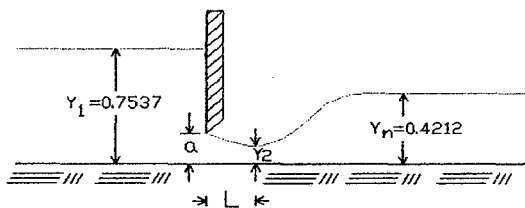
COMPUERTA DE LIMPIA DEL DESARENADOR
